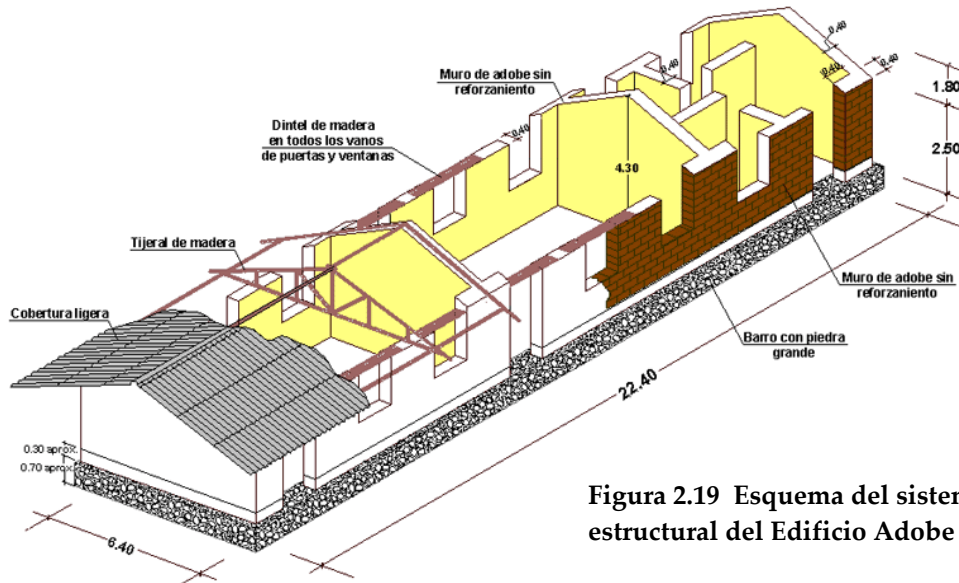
Esquema del sistema estructural del Edificio Adobe
